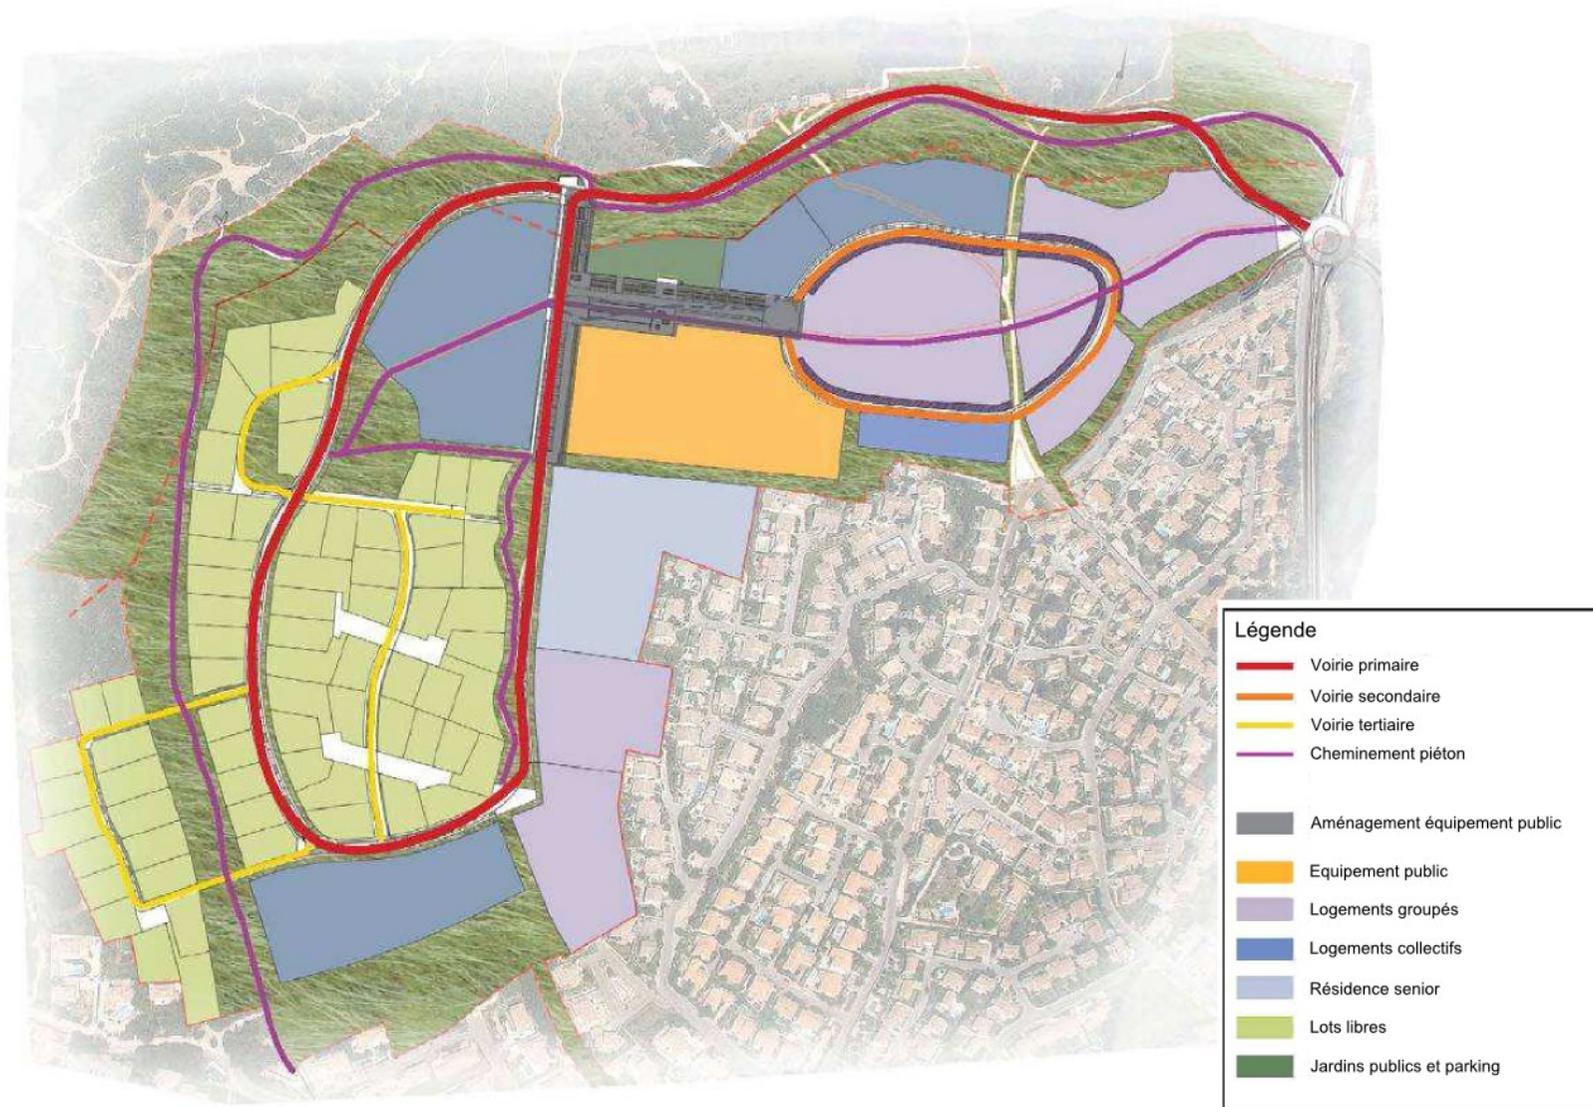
Plan masse au stade réalisation de ZAC - février 2008 (source CODRA, 2008)
